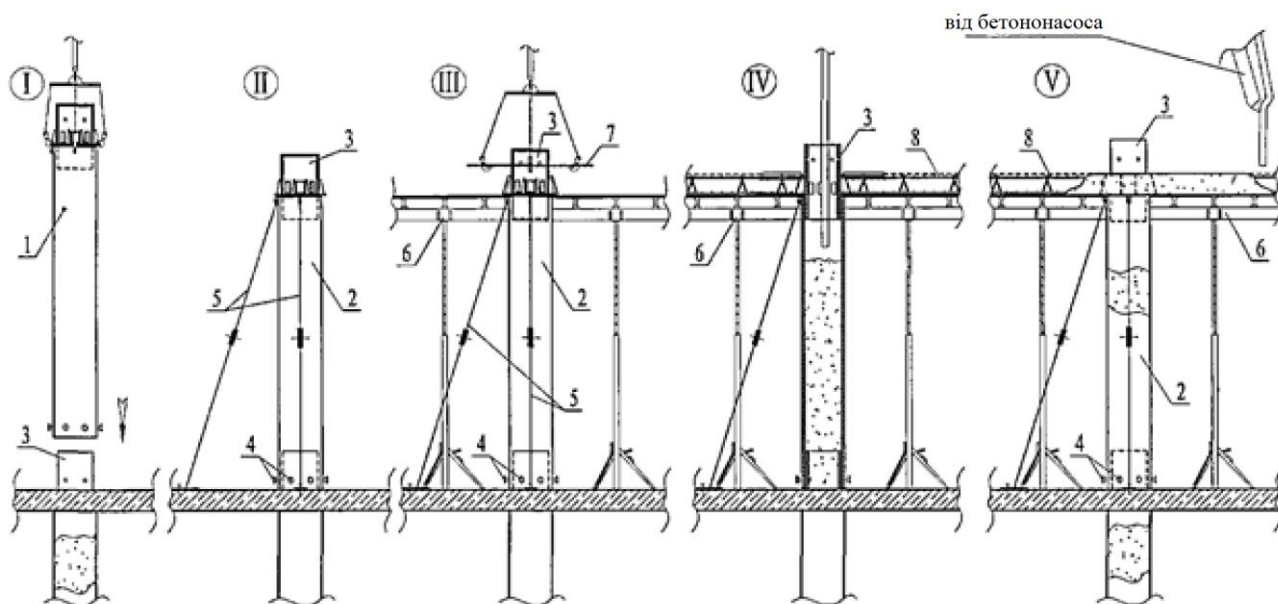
Технологічні схеми зведення несучих конструкцій каркаса будинку з колонами із трубобетона
